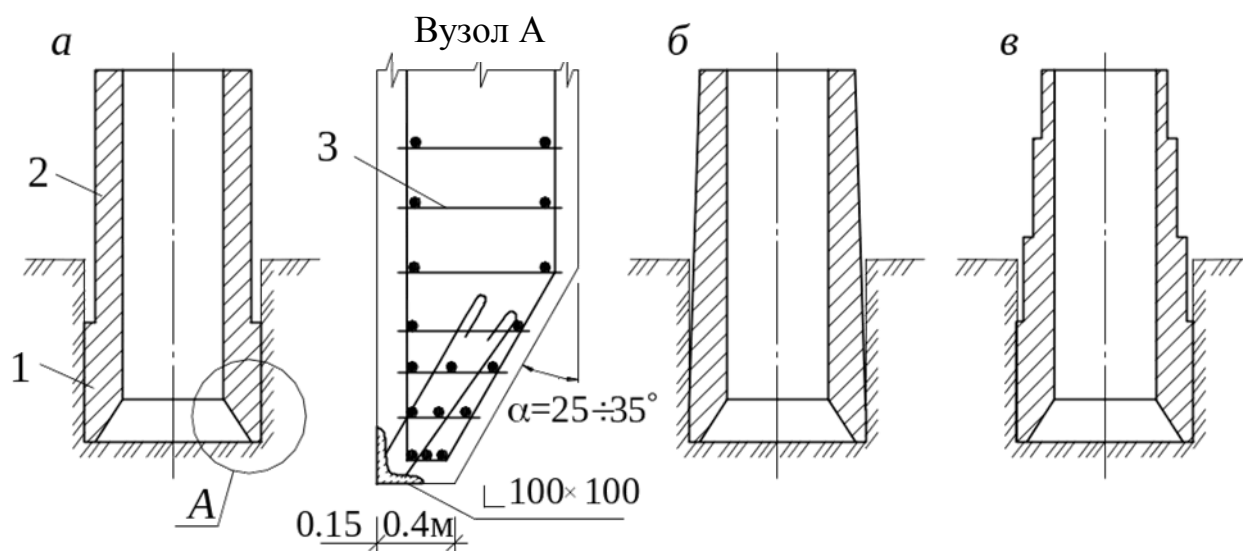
Форми вертикальних перерізів опускних колодязів: а – циліндрична; б – конічна; в – циліндрична ступінчаста; 1 – ножова частина опускного колодязя; 2 – оболонка опускного колодязя; 3 – арматура ножа колодязя
